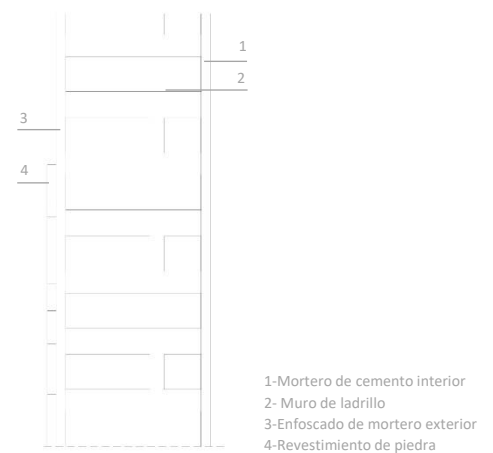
Detalle constructivo sección ampliación. Fuente: Elaboración propia.
